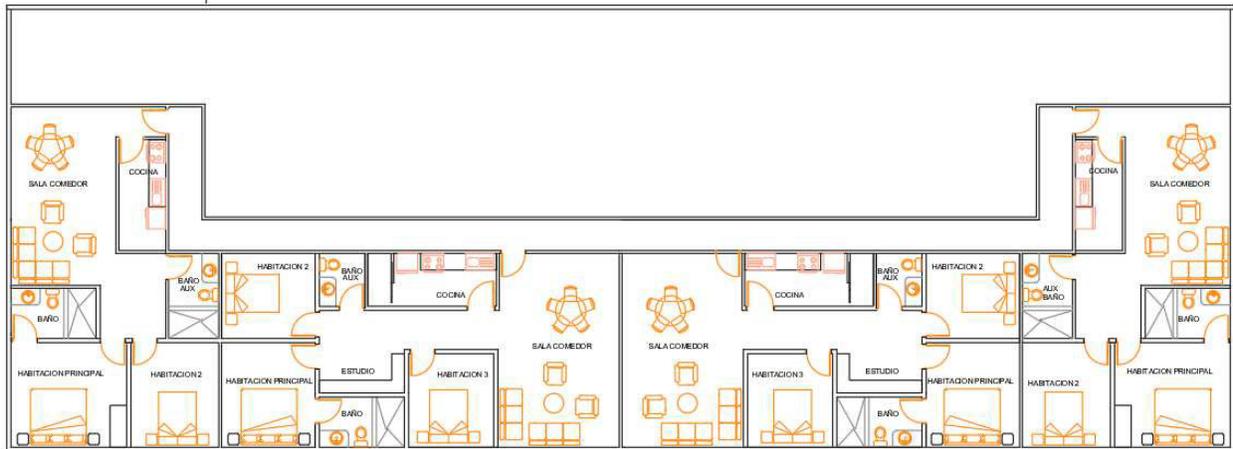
Vista en planta de piso tipo, Plano Arquitectónico
